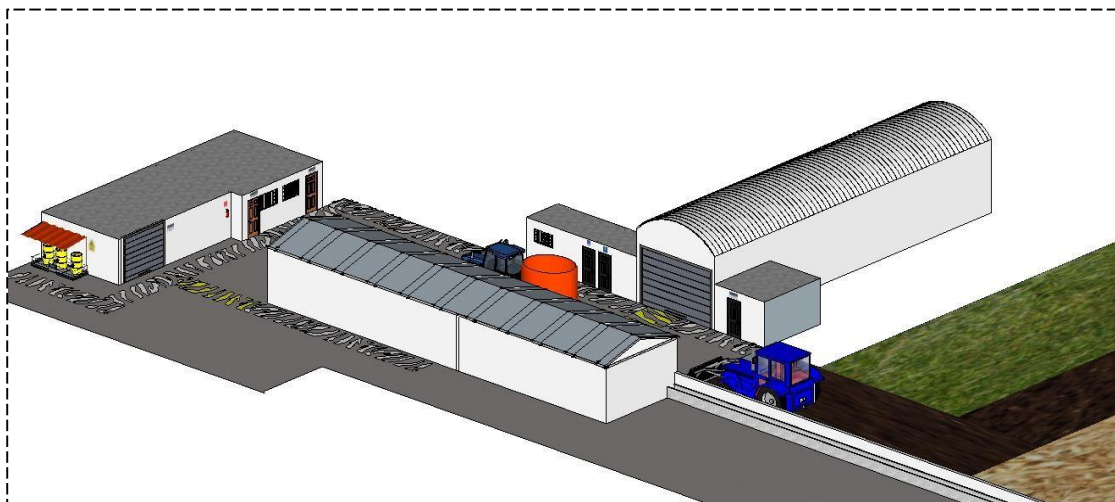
Layout 3D Planta de alimento balanceado para ganado
